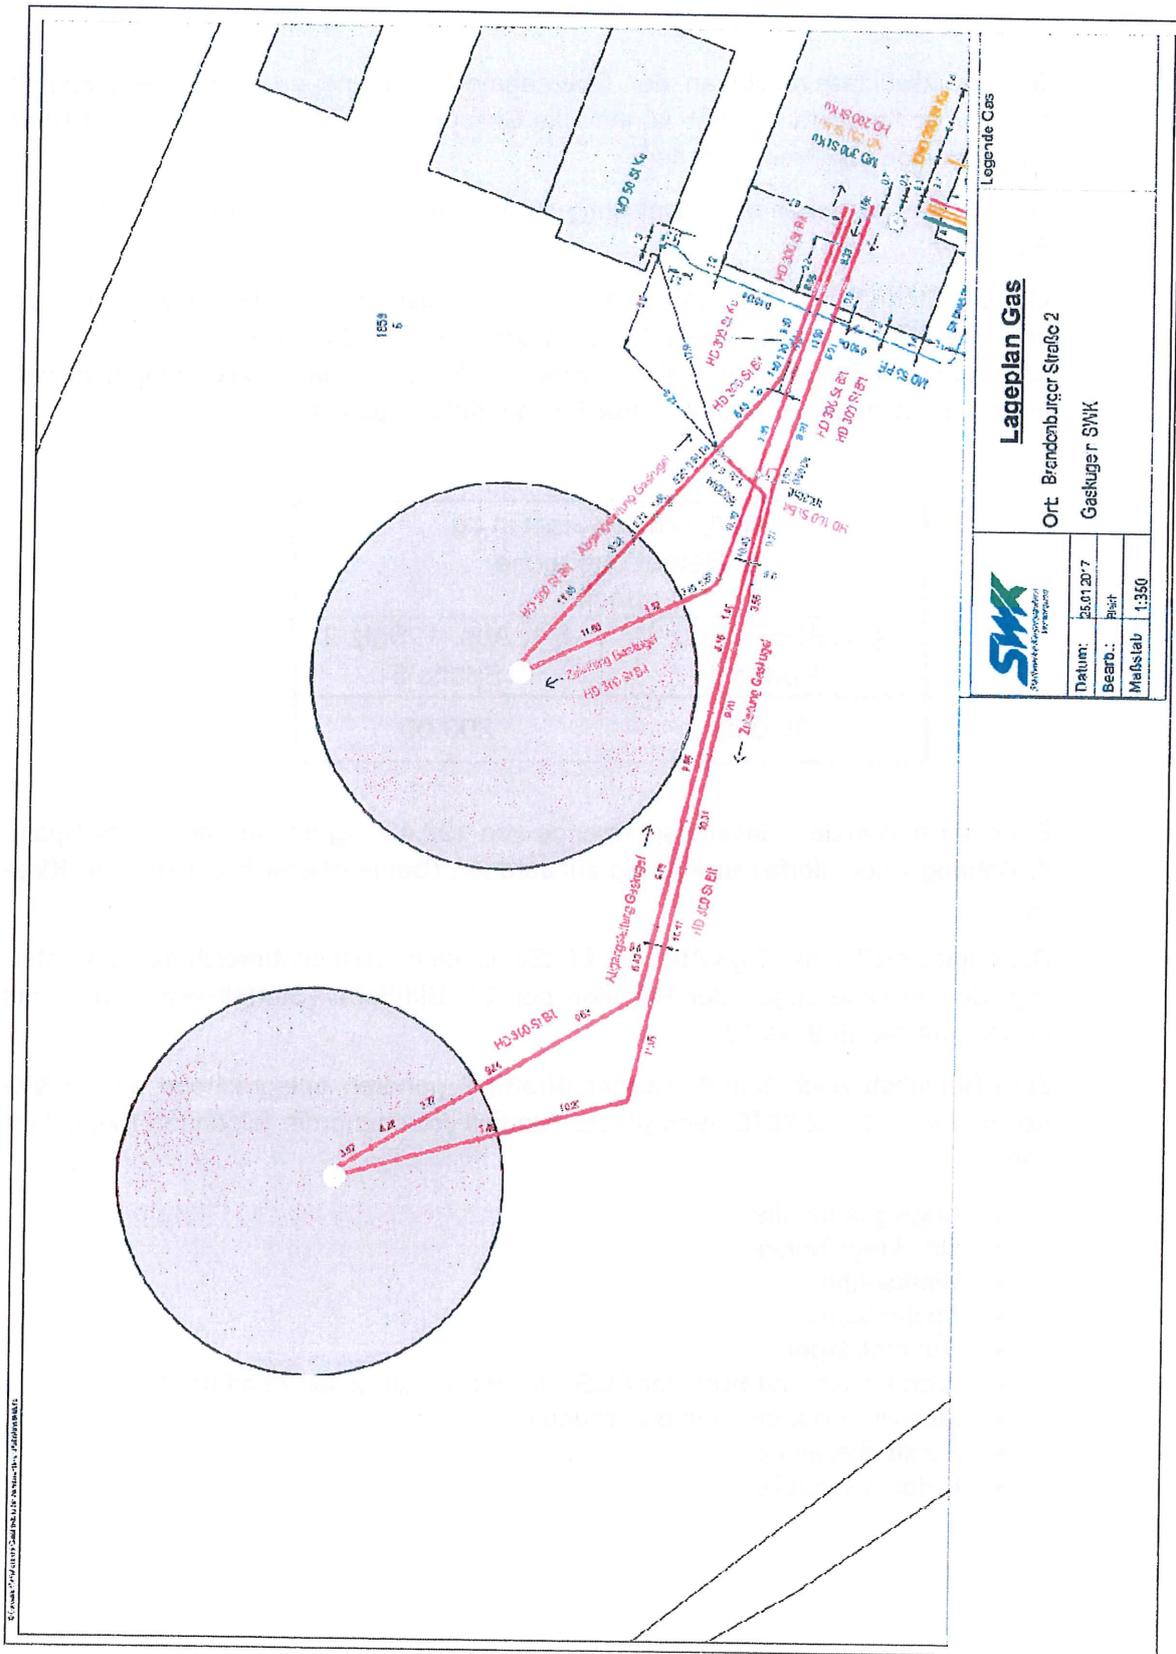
Lageplan der relevanten Rohrleitungen
